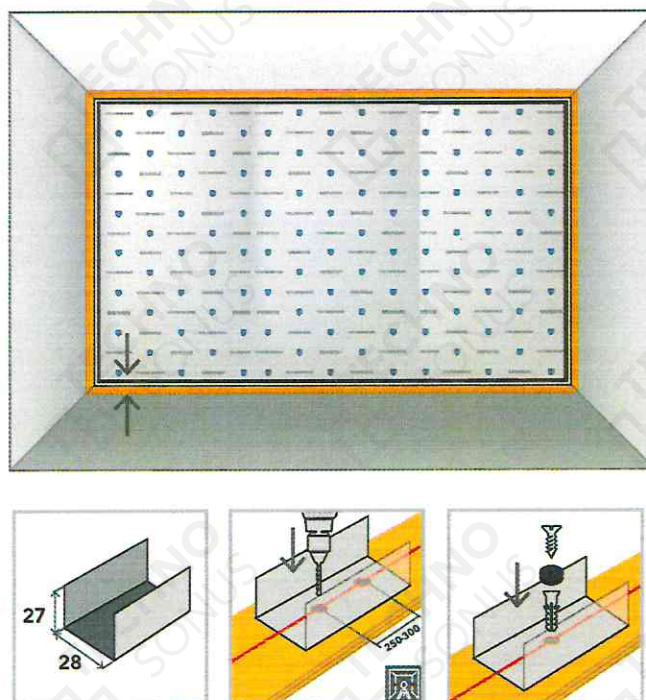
Монтаж направляющего профиля АкустикГипс ППН 28x27
